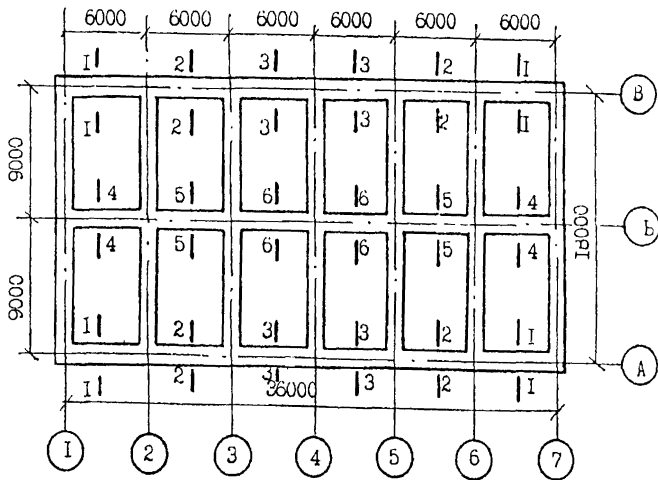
План и сечение ленточных фундаментов бескаркасного здания
